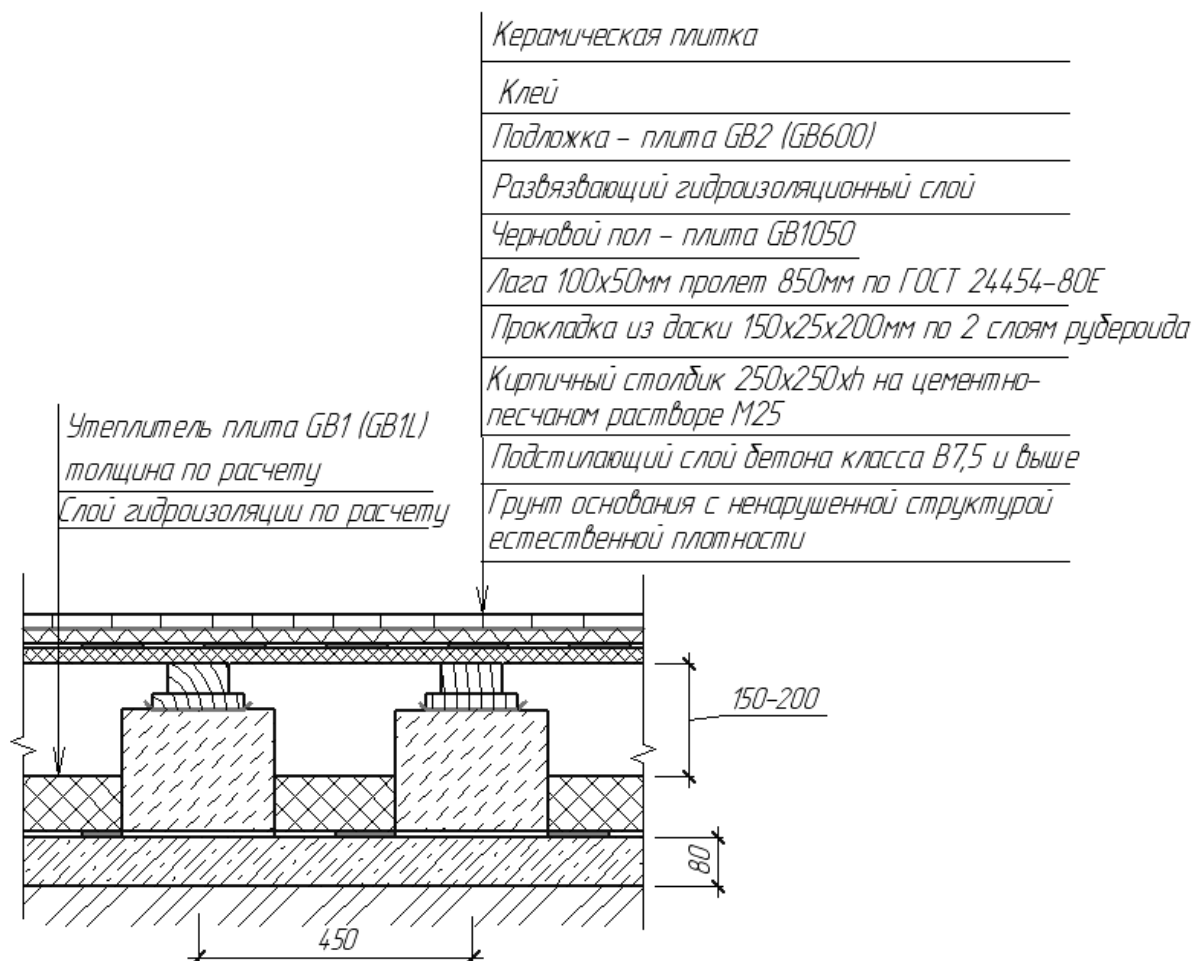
Конструкция плиточного пола №2 по грунту с утеплением на кирпичных столбах с применением системы плит GREEN BOARD®
